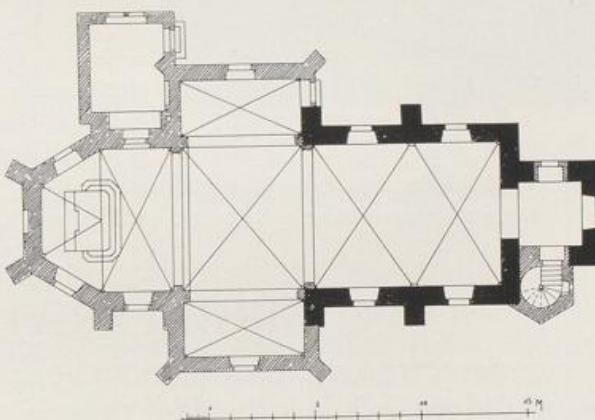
Ginnick. Grundriss der kathol. Pfarrkirche nach der Erweiterung.
